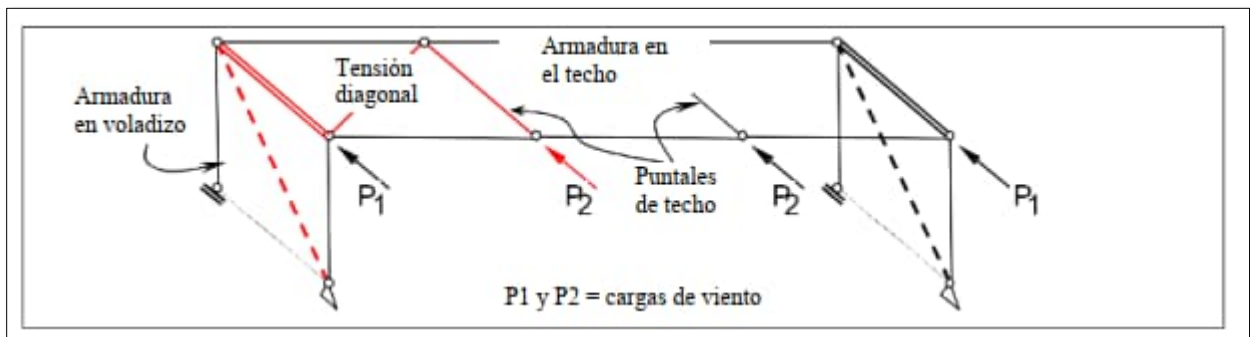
Trayectoria de las cargas de viento aplicadas en un muro cabecero
